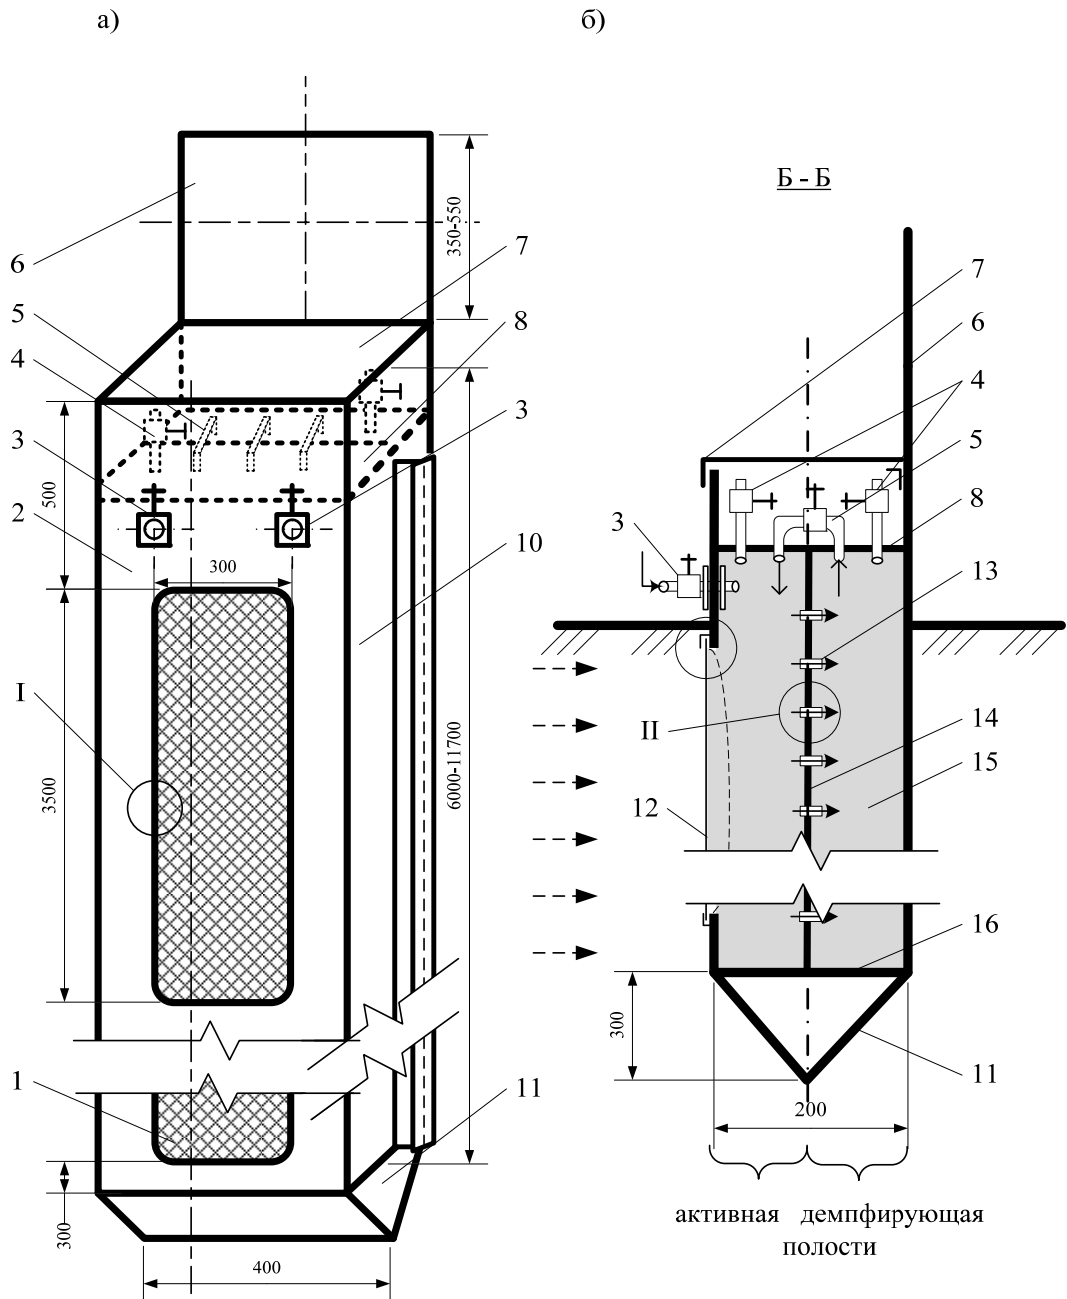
Внешний вид элемента системы защиты (а) и его поперечный разрез (б): 1 – мембраны из полимерного материала; 2 – наружная стенка с продольными окнами; 3 – муфты с вентилями; 4, 5 – соответственно трубопроводы подачи и перелива демпфирующей жидкости; 6 – пластина крепления гидравлического зажима вибропогрузателя; 7 – съемная крышка; 8 – верхняя заглушка; 9 – замковые элементы; 10 – боковые стенки; 11 – направляющий элемент нижнего торца; 12 – мембрана; 13 – дроссельные элементы; 14 – внутренняя стенка; 15 – демпфирующая жидкость; 16 – нижняя сплошная заглушка
